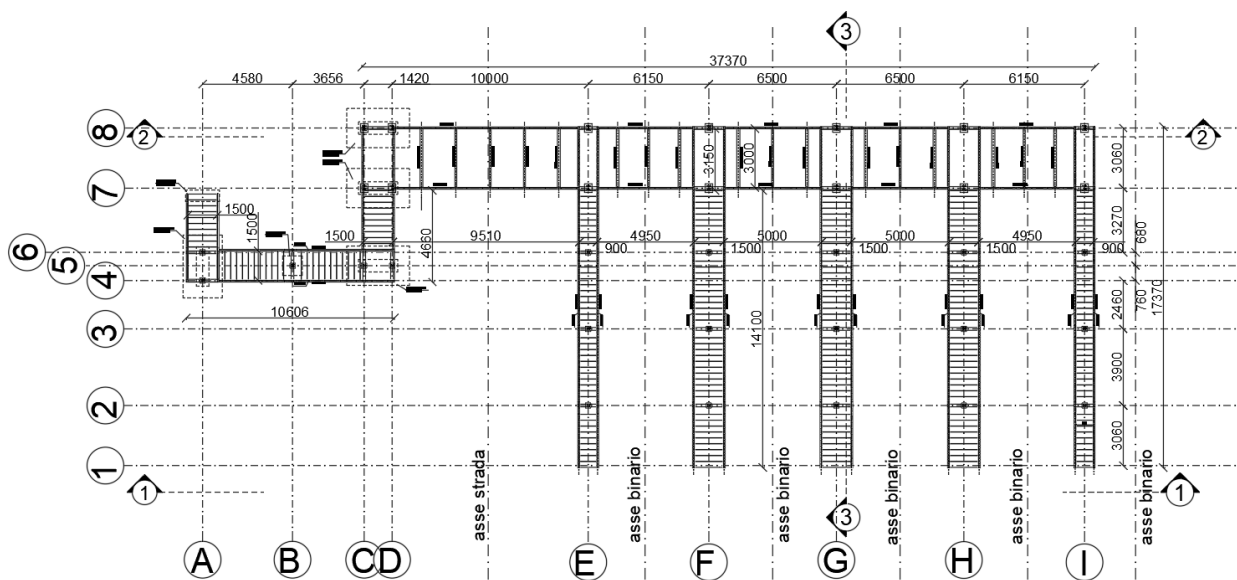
PASSERELLA PEDONALE METALLICA - PIANTA
